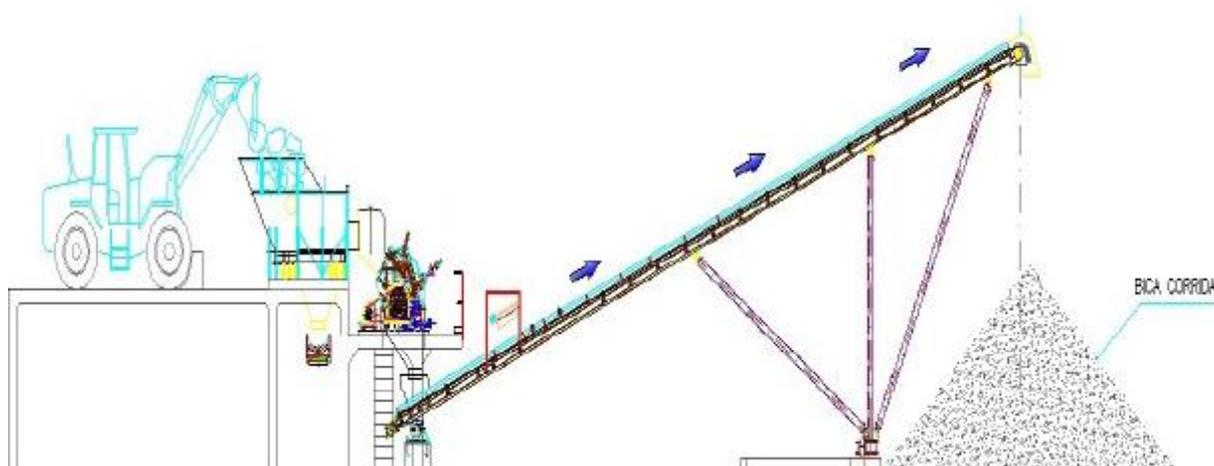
Cor te de Layout de equipamentos – UTRCD
